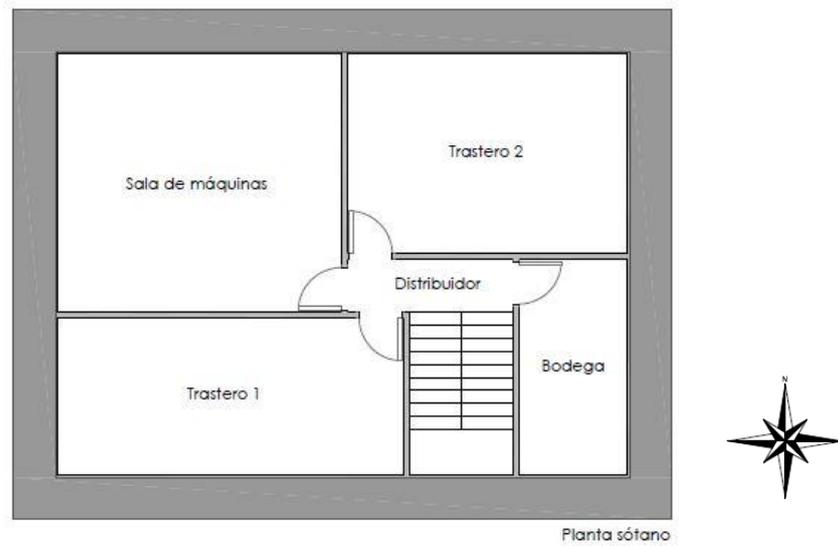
Planta sótano. Fuente: Elaboración propia.
